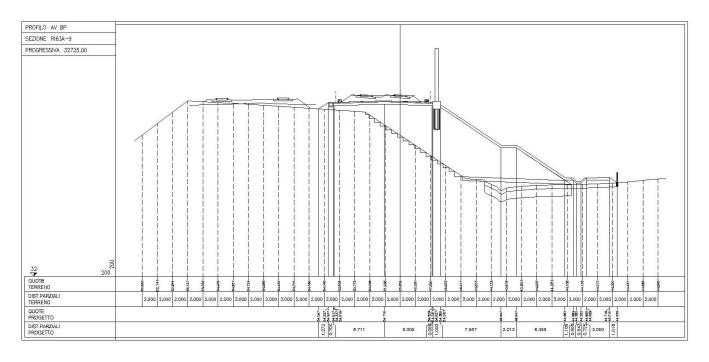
Sezione di riferimento n° 9 (pk 32+725,00) estratta da sezioni PE (Doc Rif. [1])
